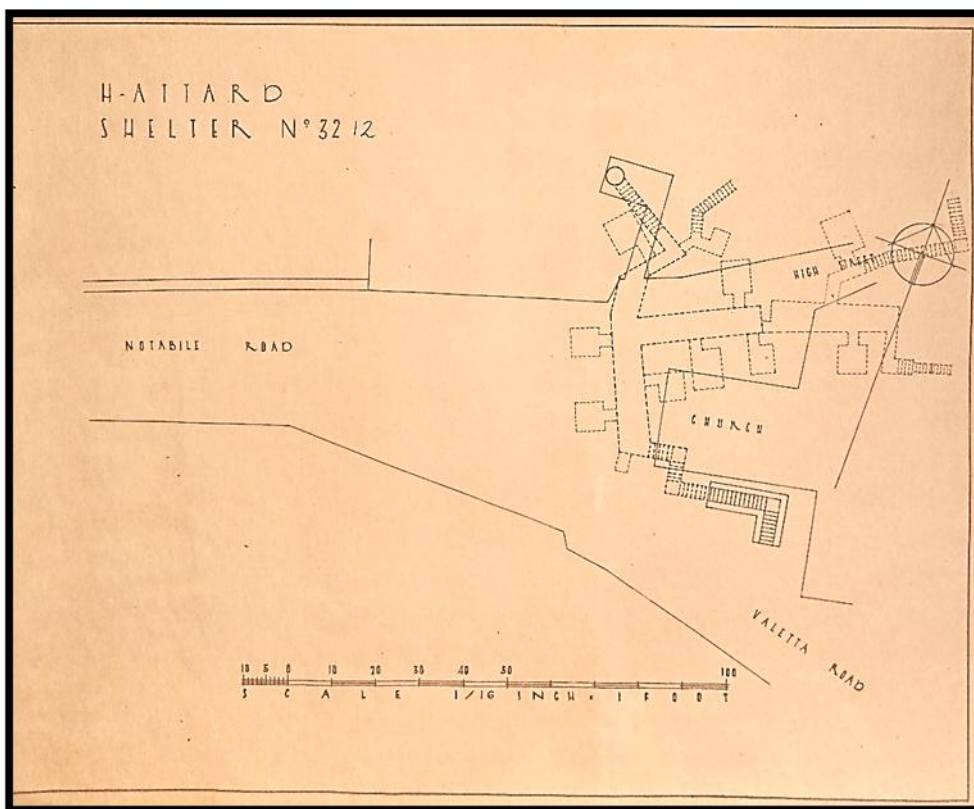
Planta do Abrigo nº12 (32) "Notable Road – Valletta Road."
